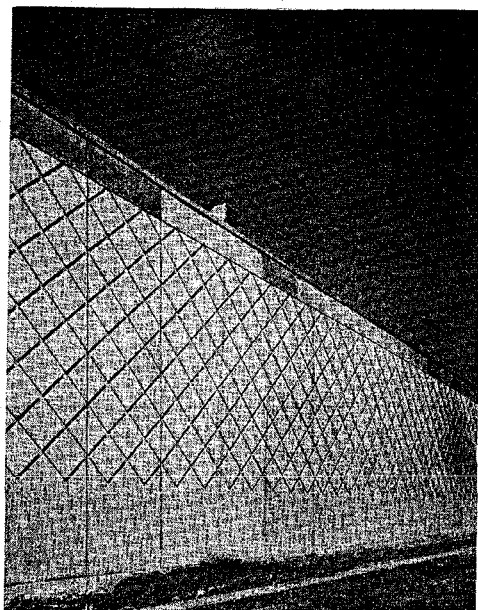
NKT, Vibholm. 10 m høje facadeelementer af sandwich-konstruktion med lecbeton som isolering.
